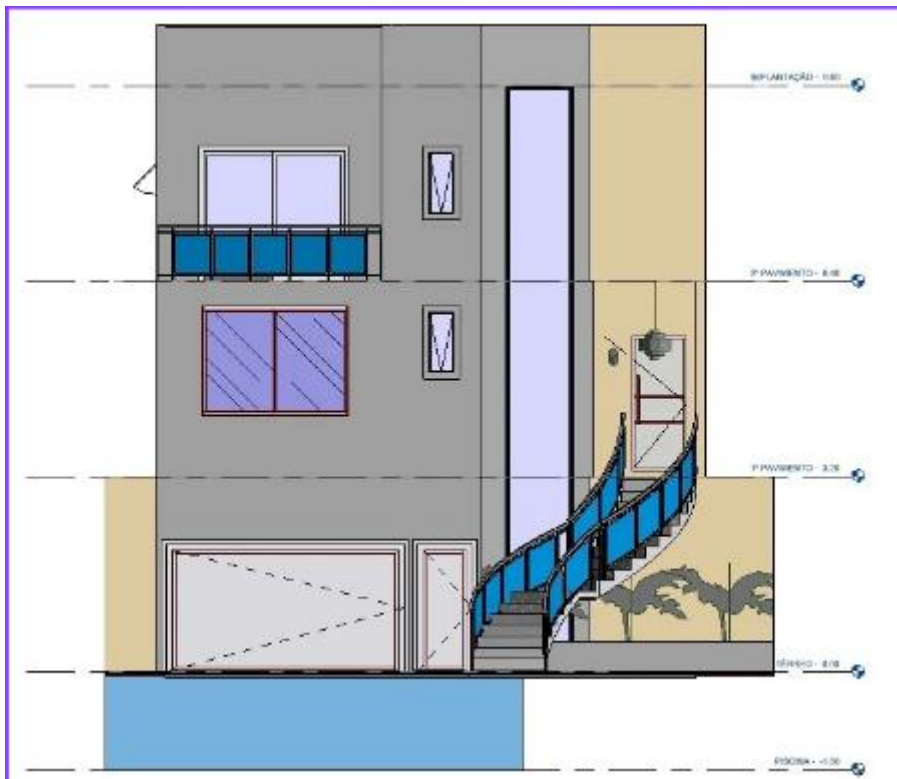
Projeto da residência em elevação frontal (Fachada). Fonte: Autores, 2024.
